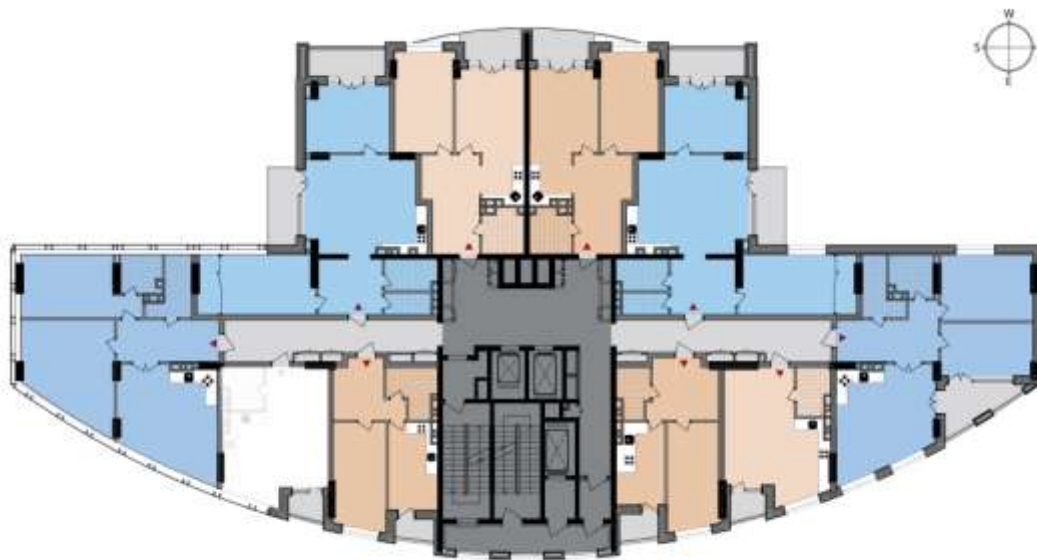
План типового поверху ЖК «А52», Київ, 2017 р. [9]
